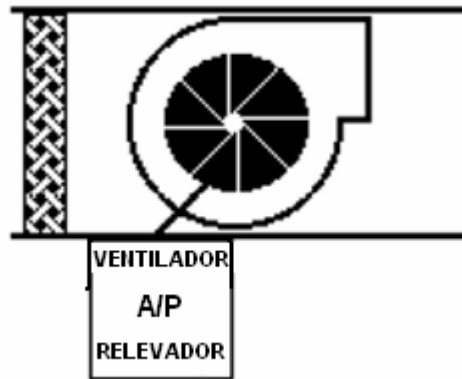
VENTILADOR DE INYECCION CON RELEVADOR DE ARRANQUE/PARO
